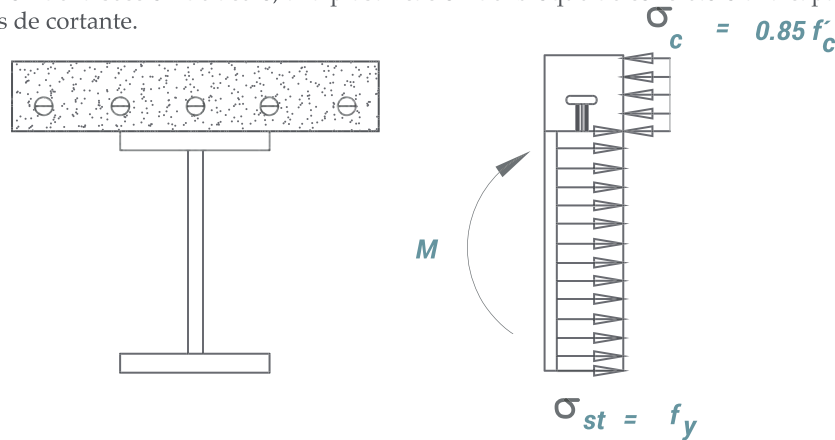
Vigas que soportan una con losa de concreto reforzado.
